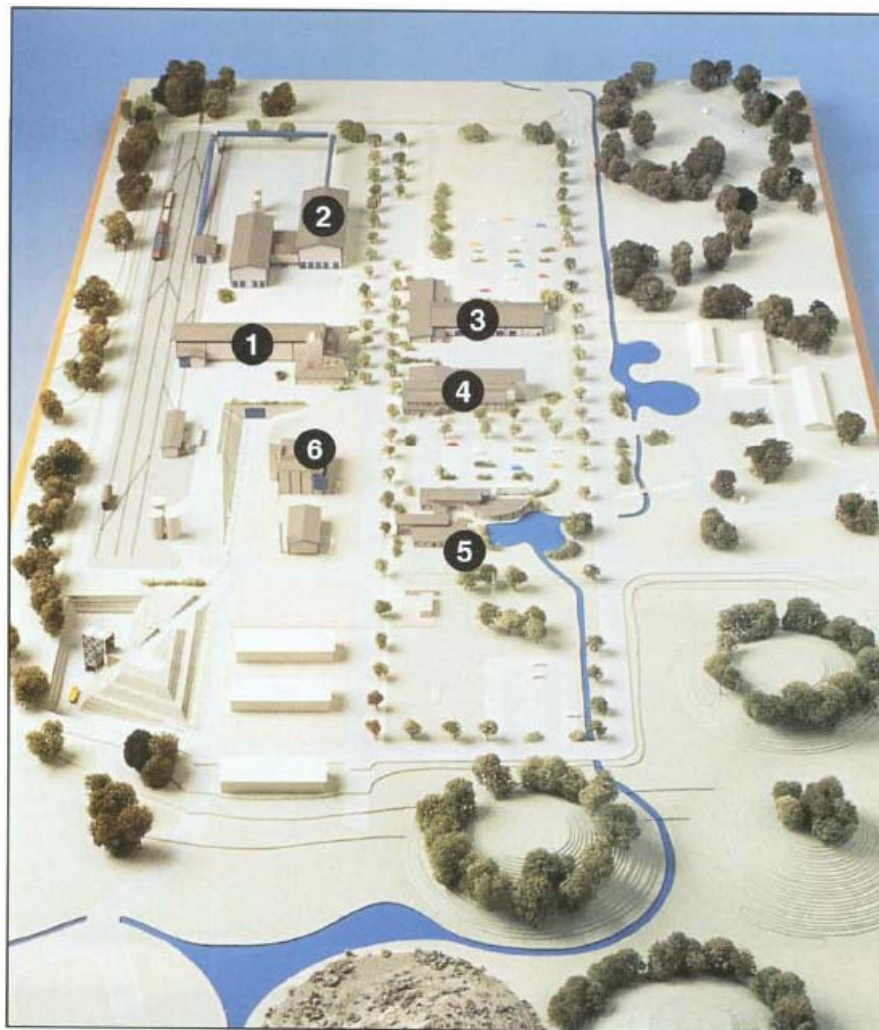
Desenho esquemático da área industrial de um repositório (maquete)
